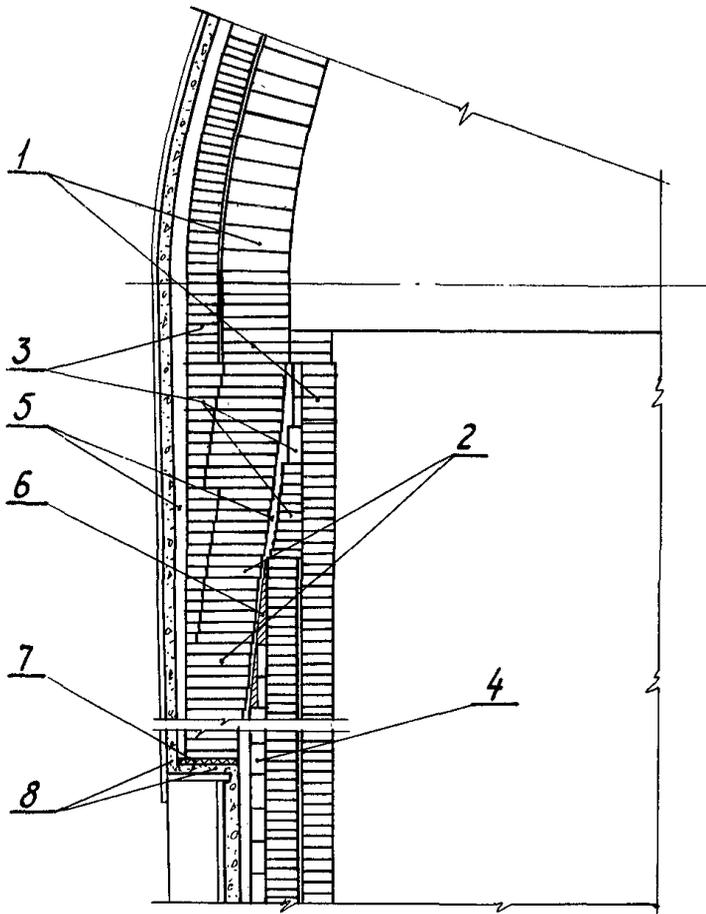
Кладка купола воздухонагревателя с опиранием на самостоятельную опору:
